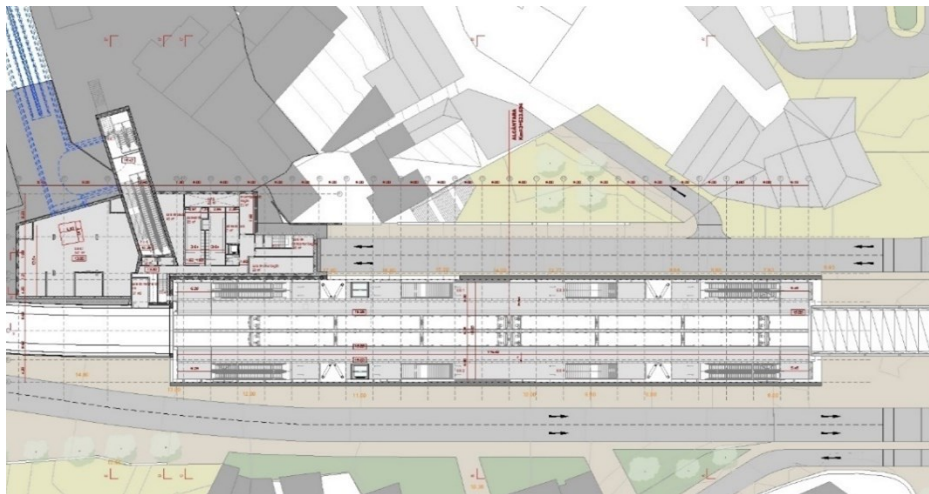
Planta Piso 1 - Cais ML (ML 134351)
